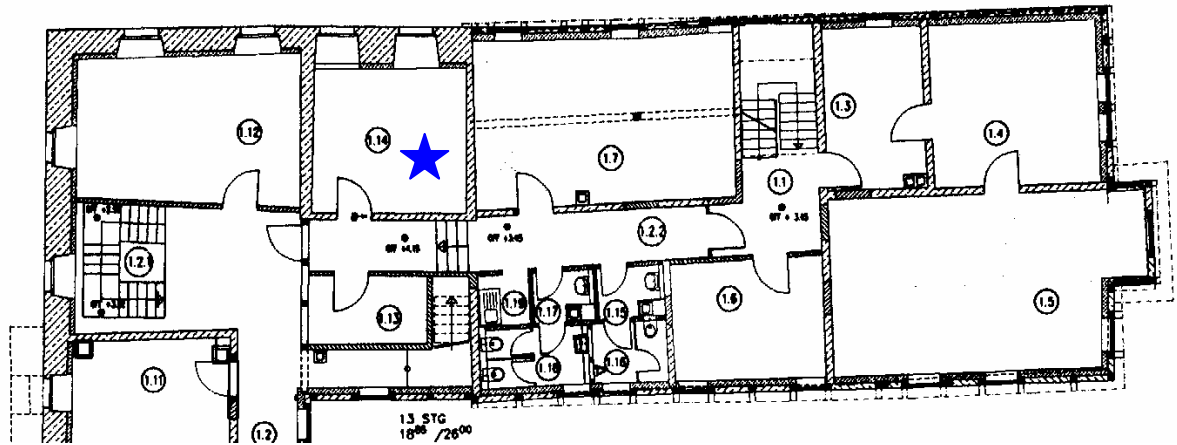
Grundriss 1.Obergeschoss
